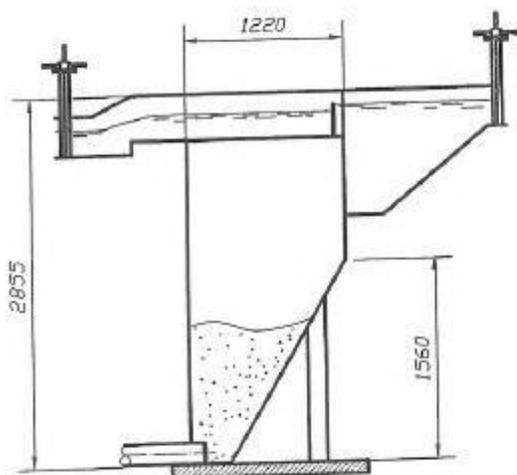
Габаритные размеры песколовки. Количество песколовок 2 шт.
